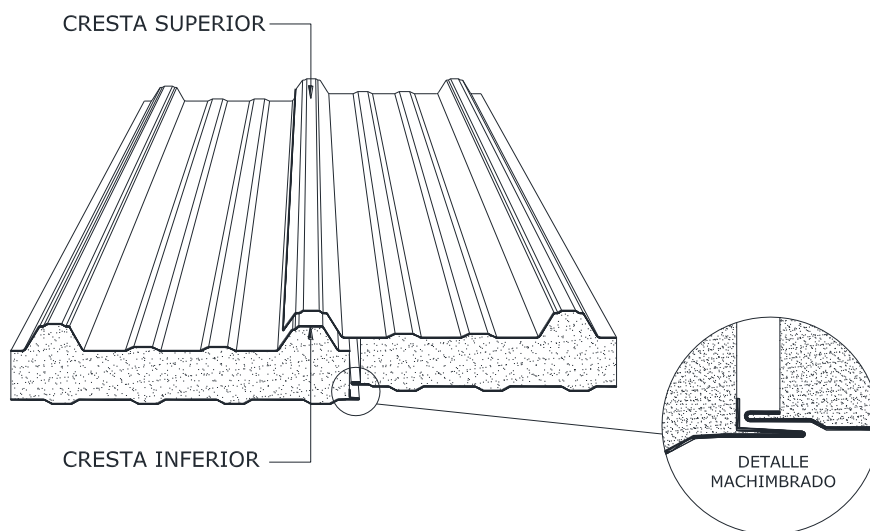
Traslape entre paneles (Fuente: METCOL)
